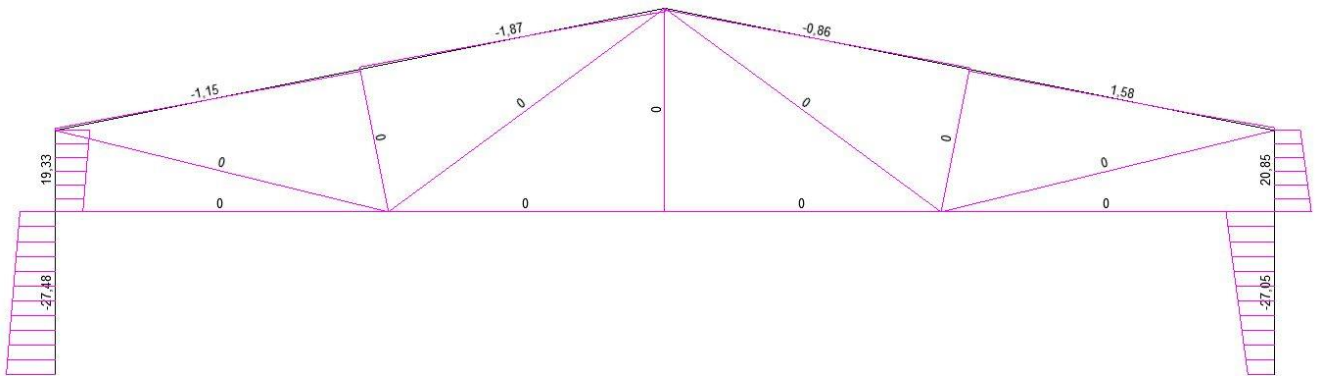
Ветровая нагрузка, 1 вариант, эпюра Q
